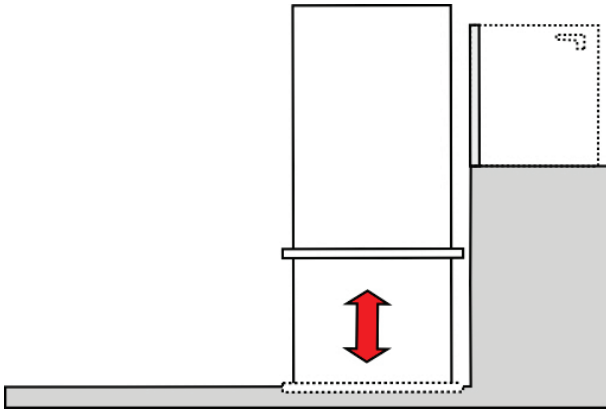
Prinzipskizze Plattformaufzug ohne Schacht
